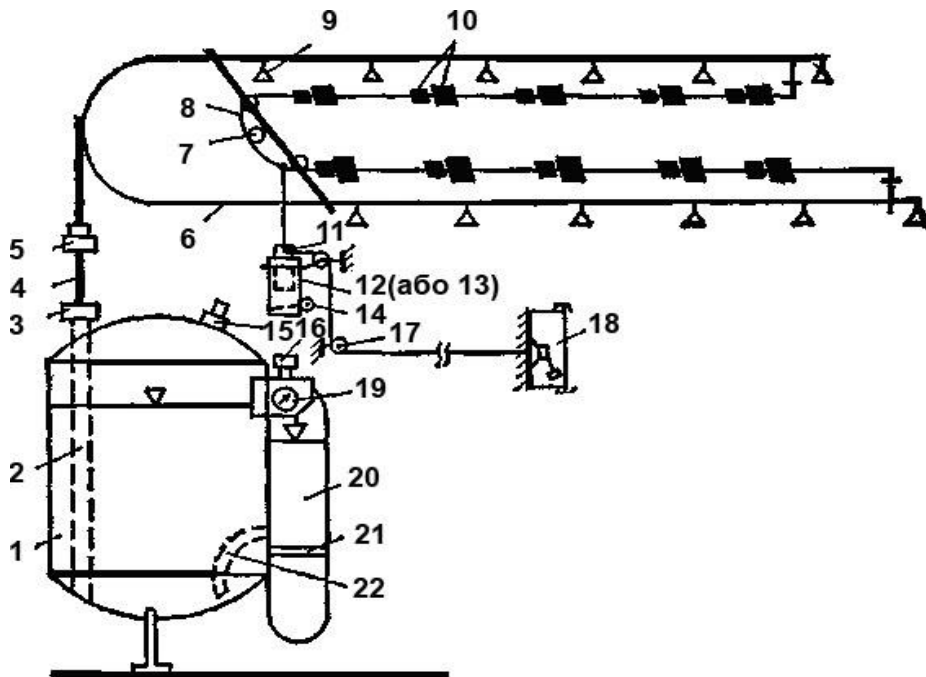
Принципова схема порошкової установки ОПА-250:
